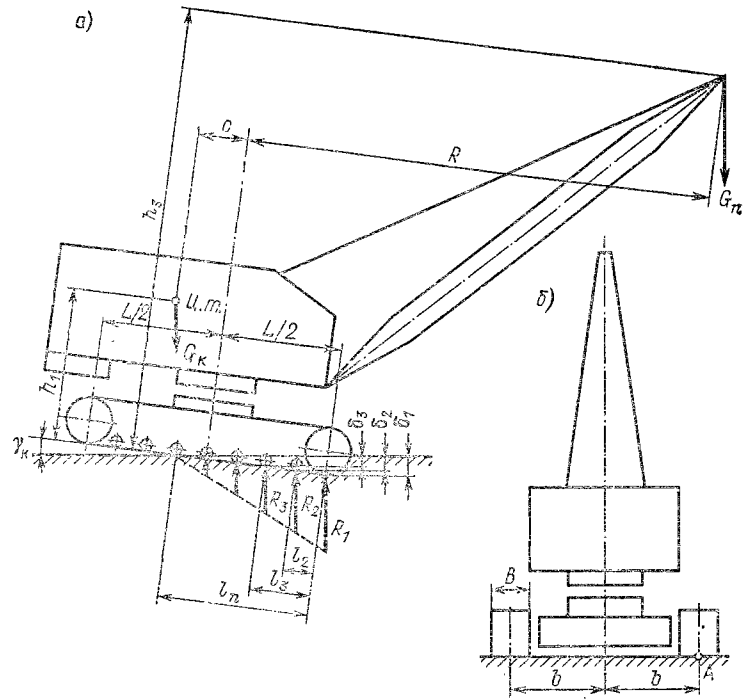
Схемы и расчеты продольной (а) и поперечной (б) устойчивости гусеничного крана
